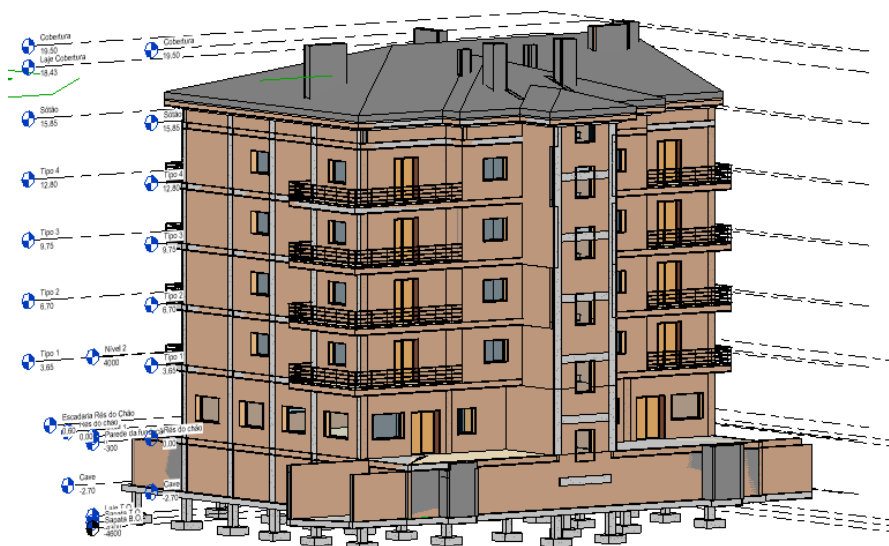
Modelo 3D vinculado ao modelo arquitetônico e estrutural.
